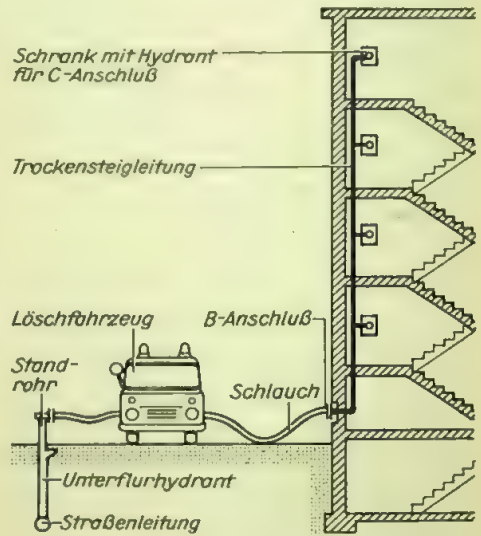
Trockene Feuerlösch-Steigleitung mit Hausanschluß für B-Rohr (70 mm Durchmesser) und Geschoßanschlüssen für C-Rohr (52 mm)
